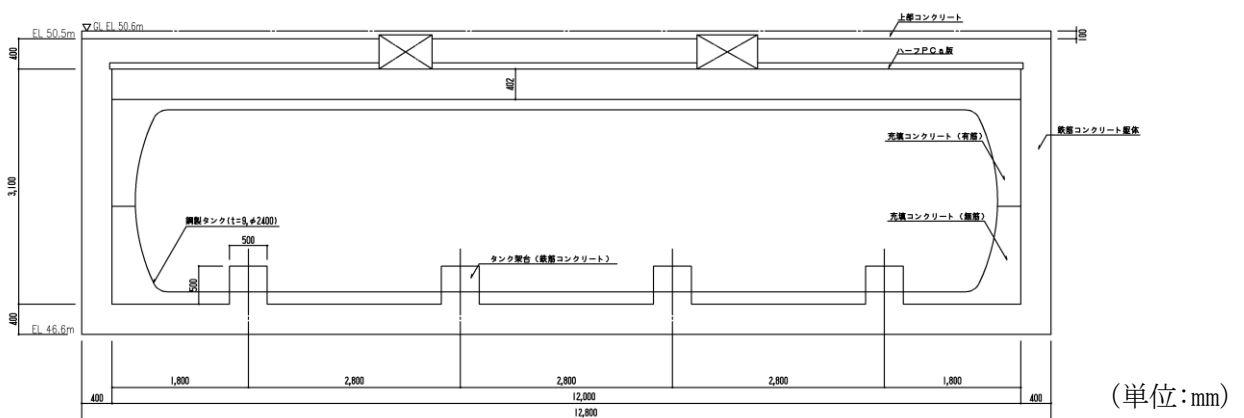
緊急時対策所用燃料地下タンク 断面図 (B-B断面)
